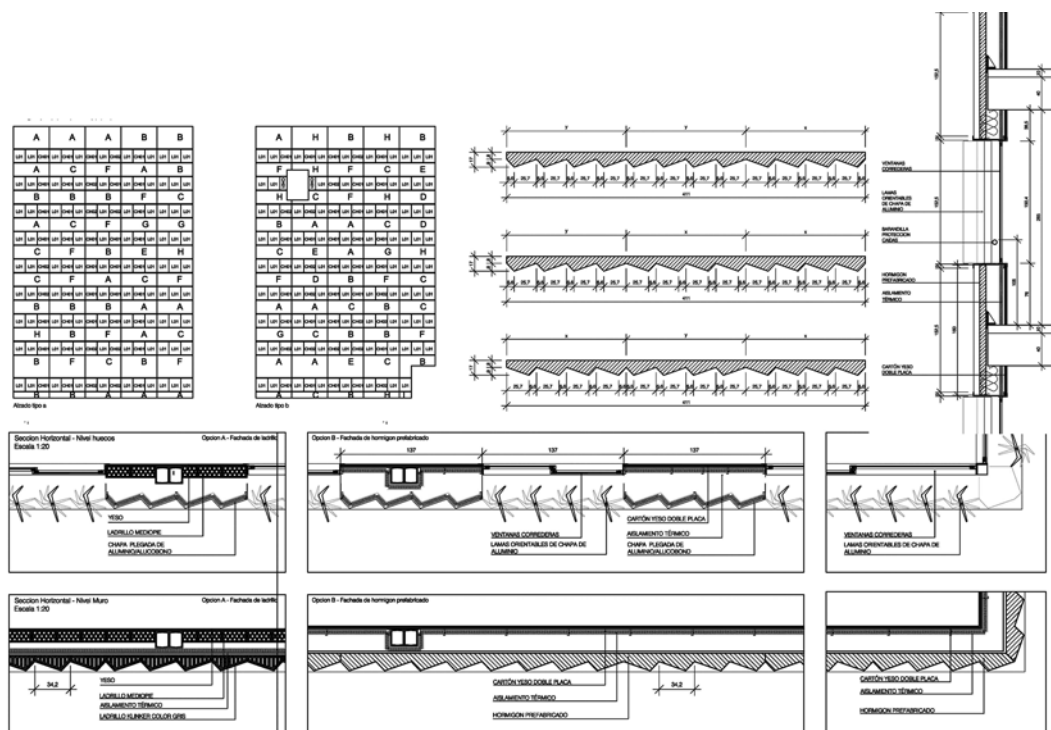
245 VPO en El Porvenir. Detalles de fachada
